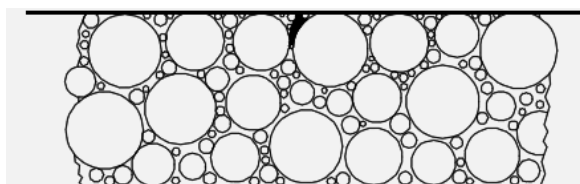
Granulometria diversa originando fissuras mais pequenas [33]
